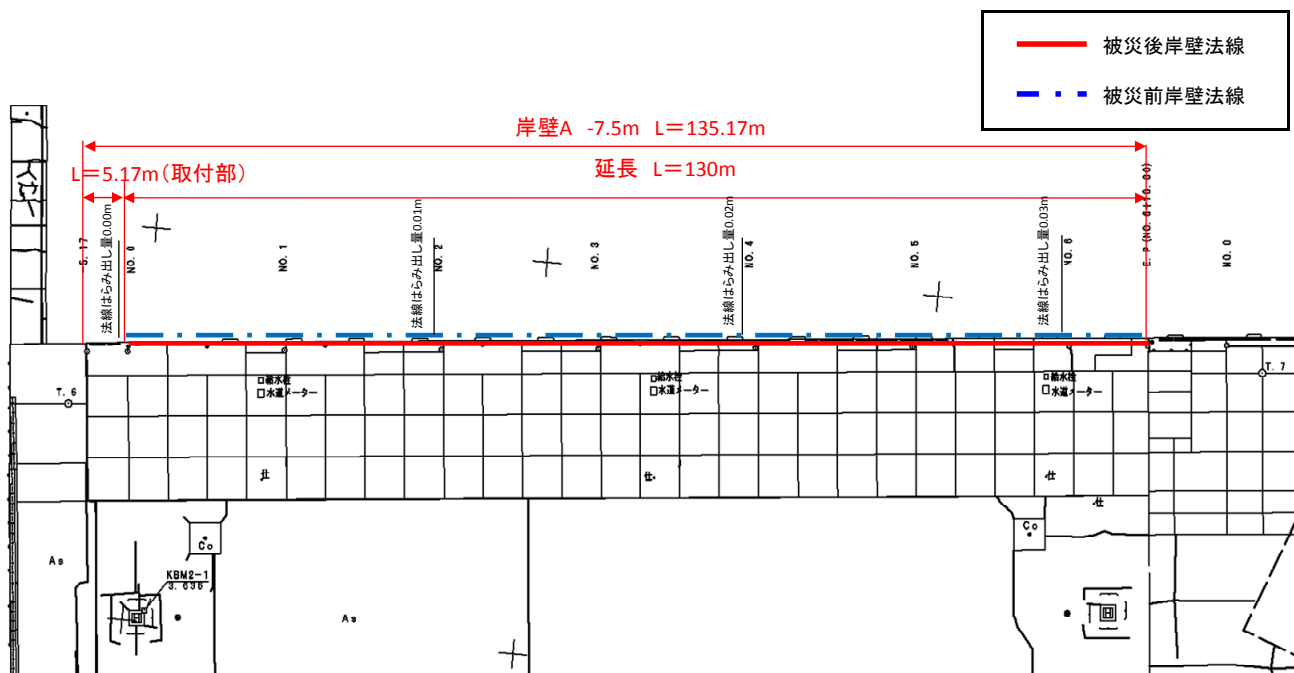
No.20 常陸那珂港区\_中央ふ頭地区岸壁（-7.5m）の平面図（被災後）
